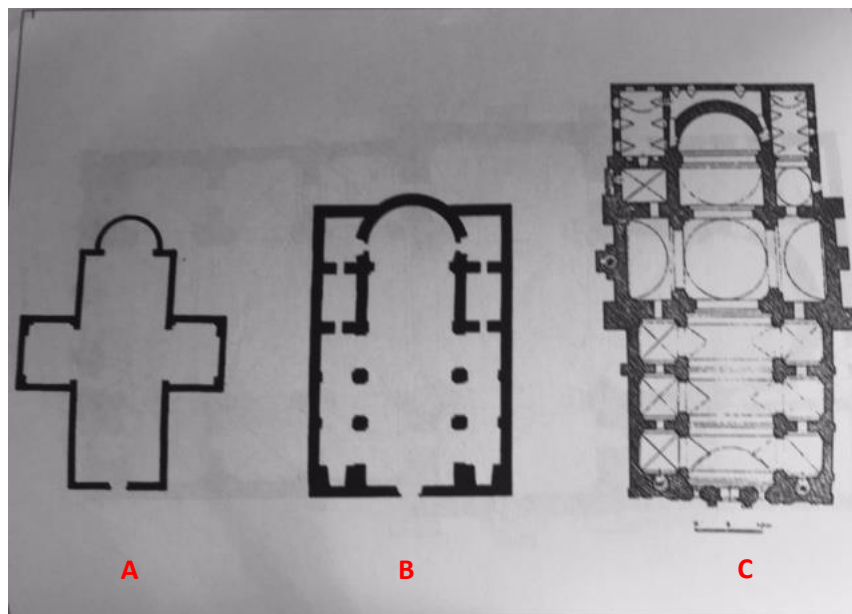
Grundrisse: „A“ St. Johannes Kathedrale in Jaroslau, „B“ St. Johannes-Kathedrale in Lublin und „C“ SS. Peter und Paul Kirche in Krakau.
